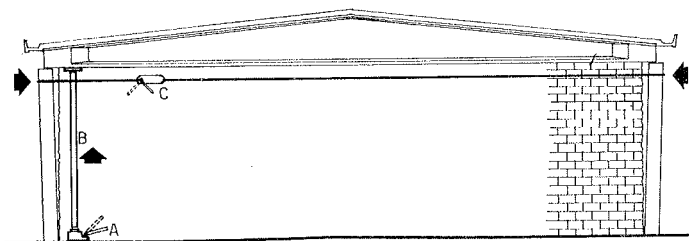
A) Martinetto idraulico; B) Dispositivo di rinvio; C) Arganetto con fune in acciaio.
